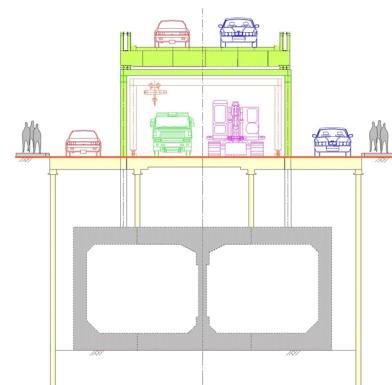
仮設迂回路全体図及び断面図 (TQB-K工法)
